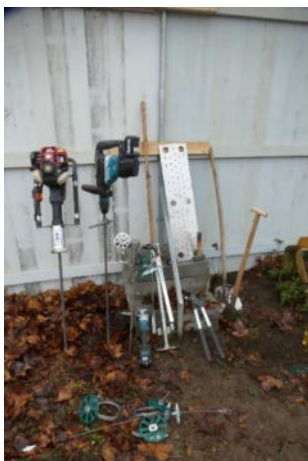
19. Grundausrüstung zum fachgerechten Einbau der Wurzelschutzbleche und -gitter (Bohrhammer, Eintriebsstange, Arretierhaken, Spannzange, Flex, Erdanker, Schutzmatten, Bleche oder Gitter).
